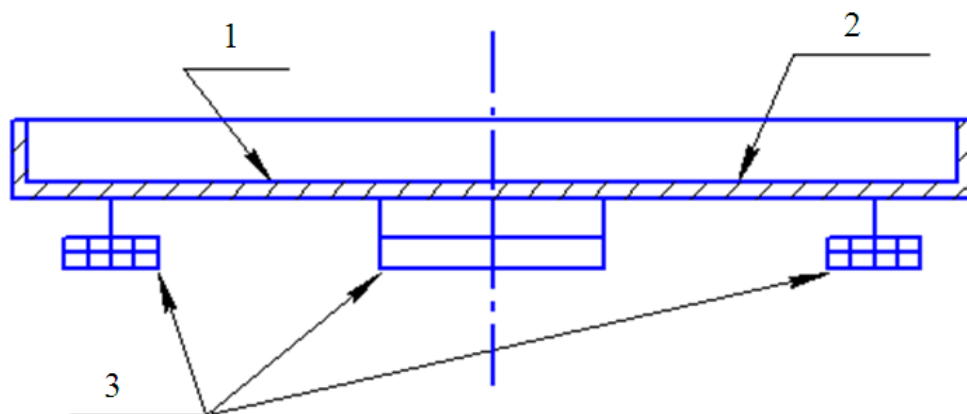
Плавающее покрытие для резервуара (вид сбоку)
